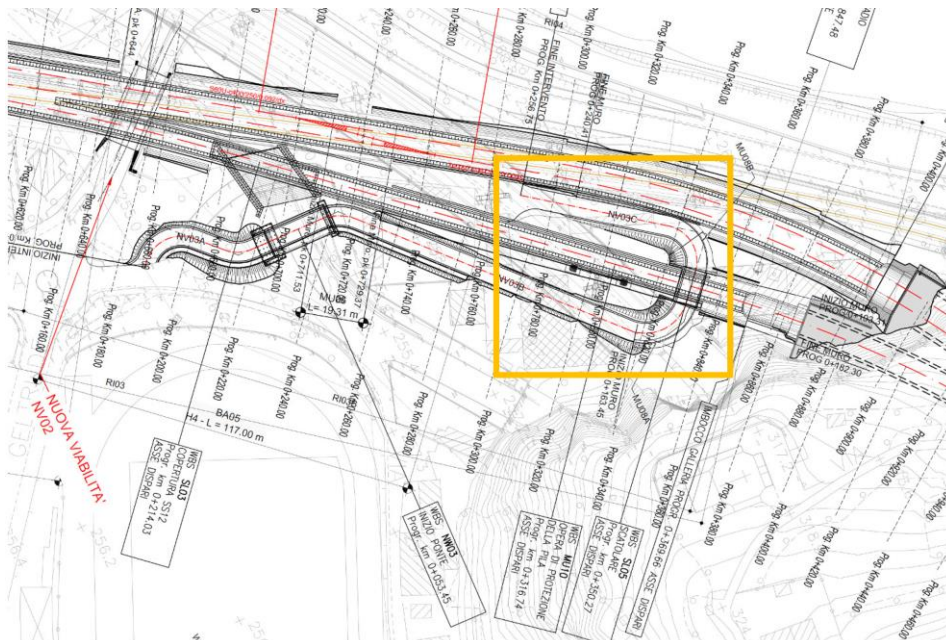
Planimetrica di progetto MU08 su viabilità NV03
